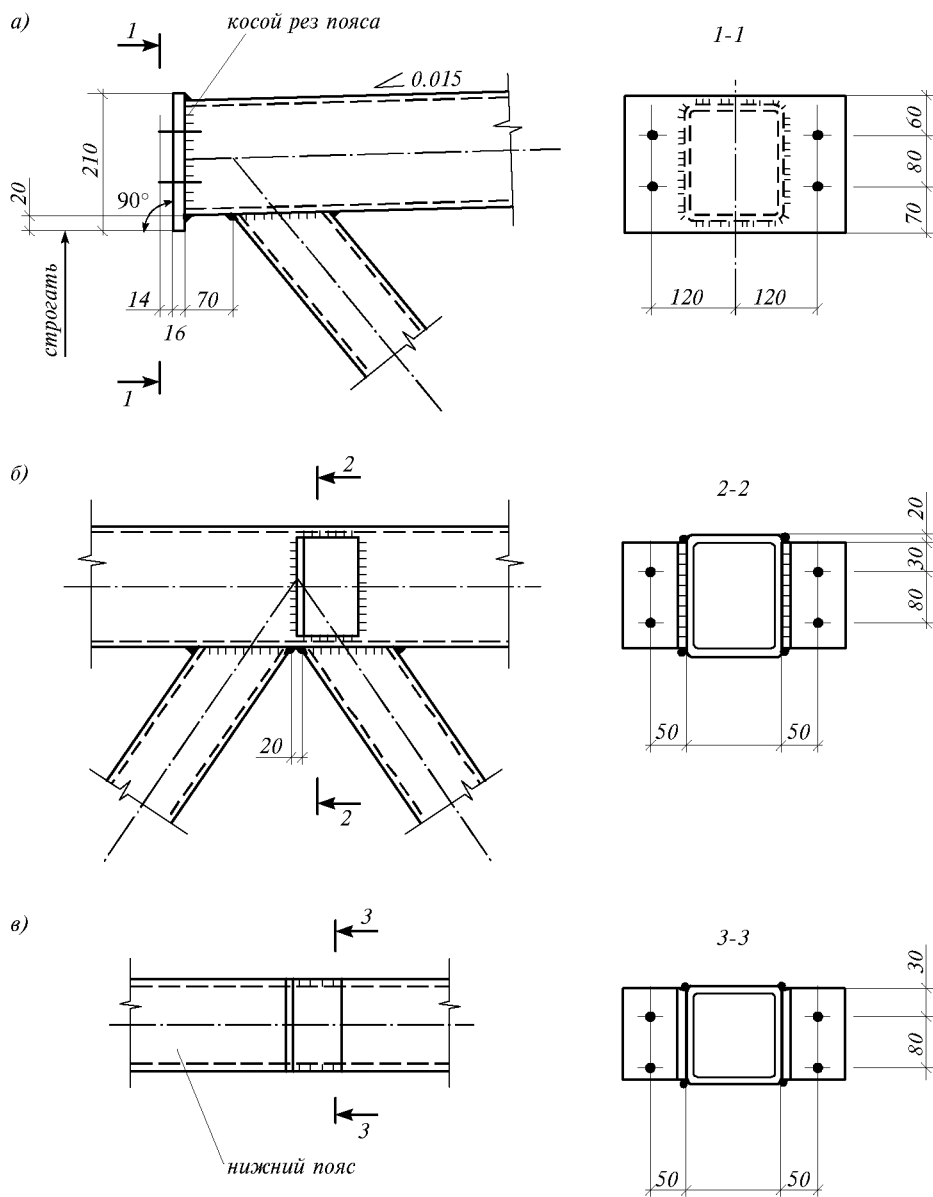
Узлы фермы из гнутосварных профилей
